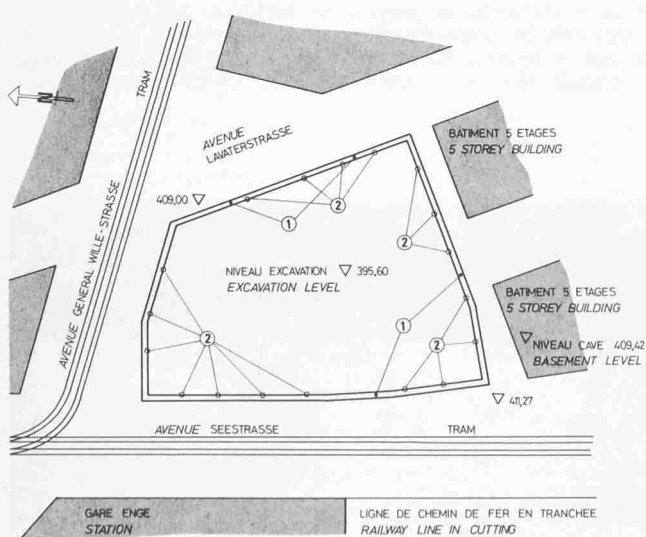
Plan de situation. 1 Deflectomètres et mesures des forces dans les tirants. 2 Repères de triangulation
